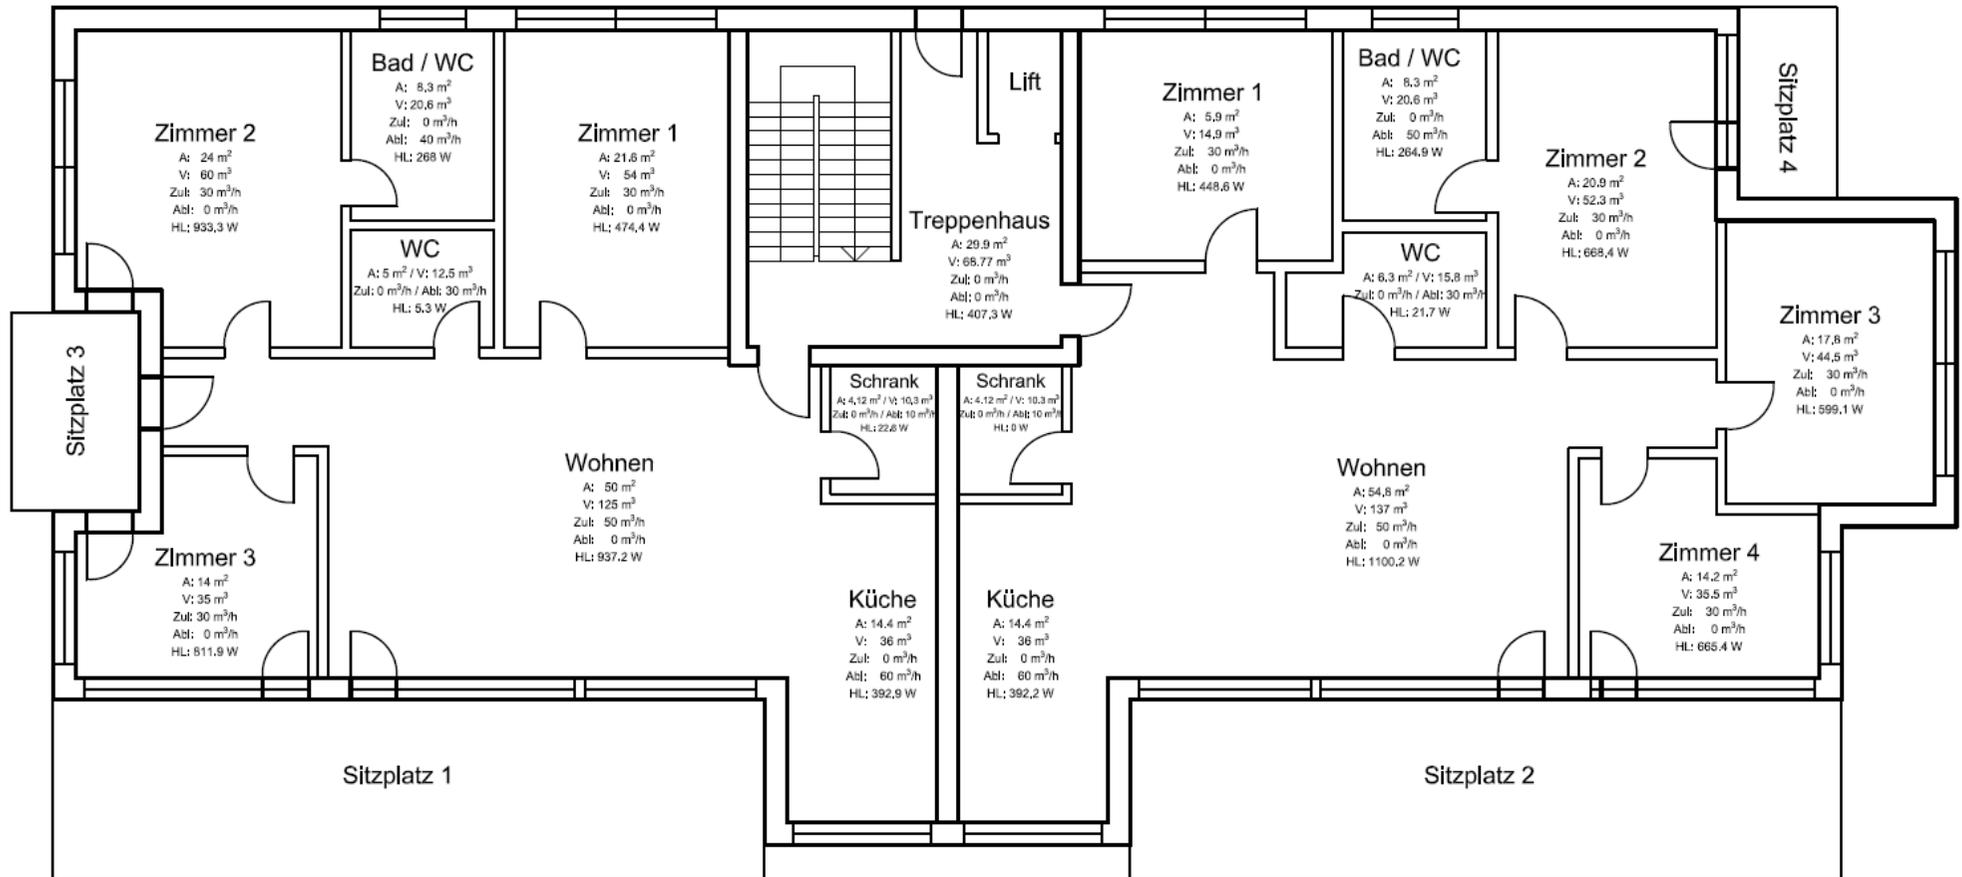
Grundriss des Erdgeschoss mit Heizleistung nach SIA 384.201.
